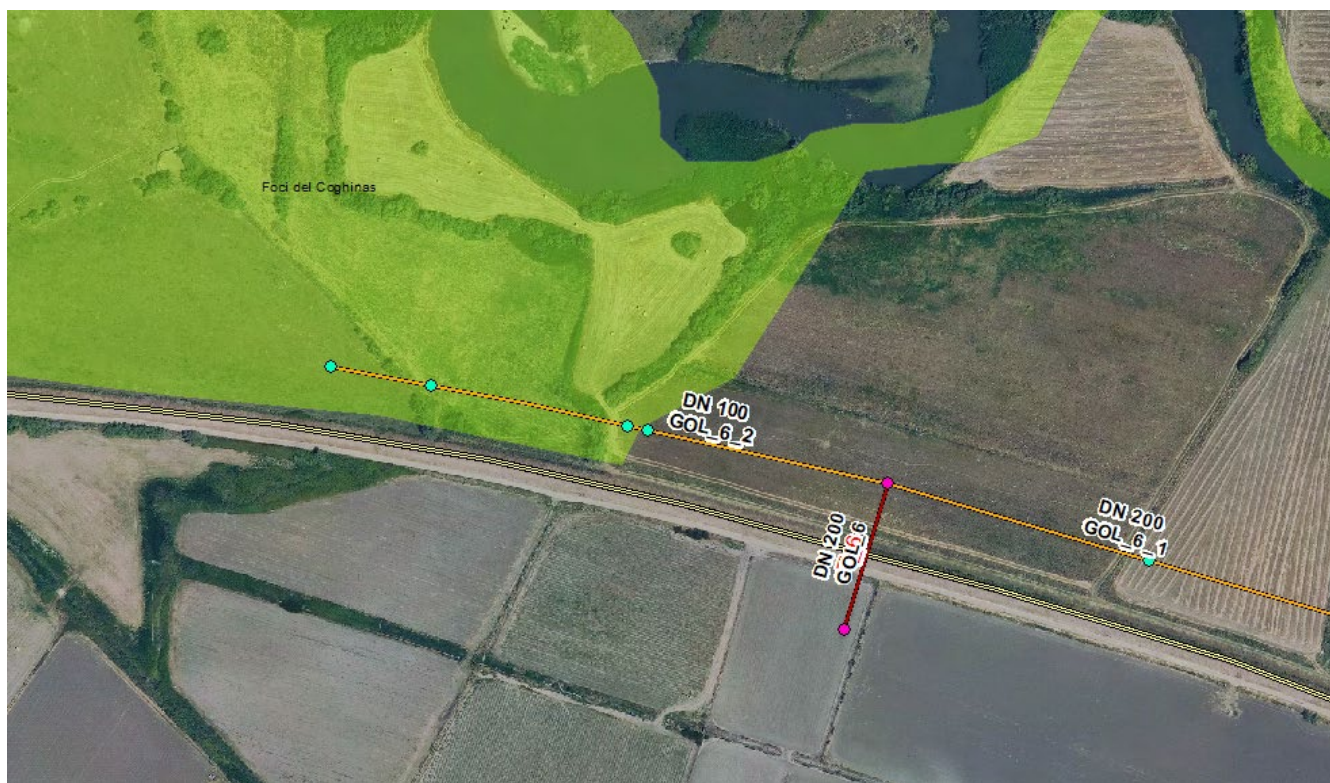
Sovrapposizione condotta GOL_6_2 di progetto con la perimetrazione delle aree di zona Z.S.C.
